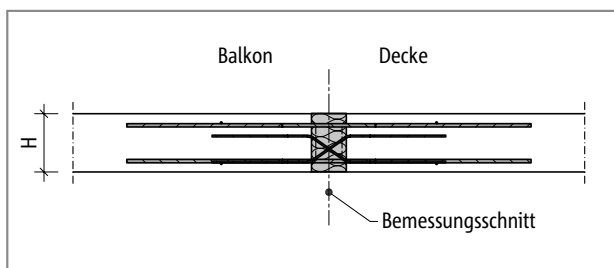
Schöck Isokorb® Typ DXT: Statisches System
